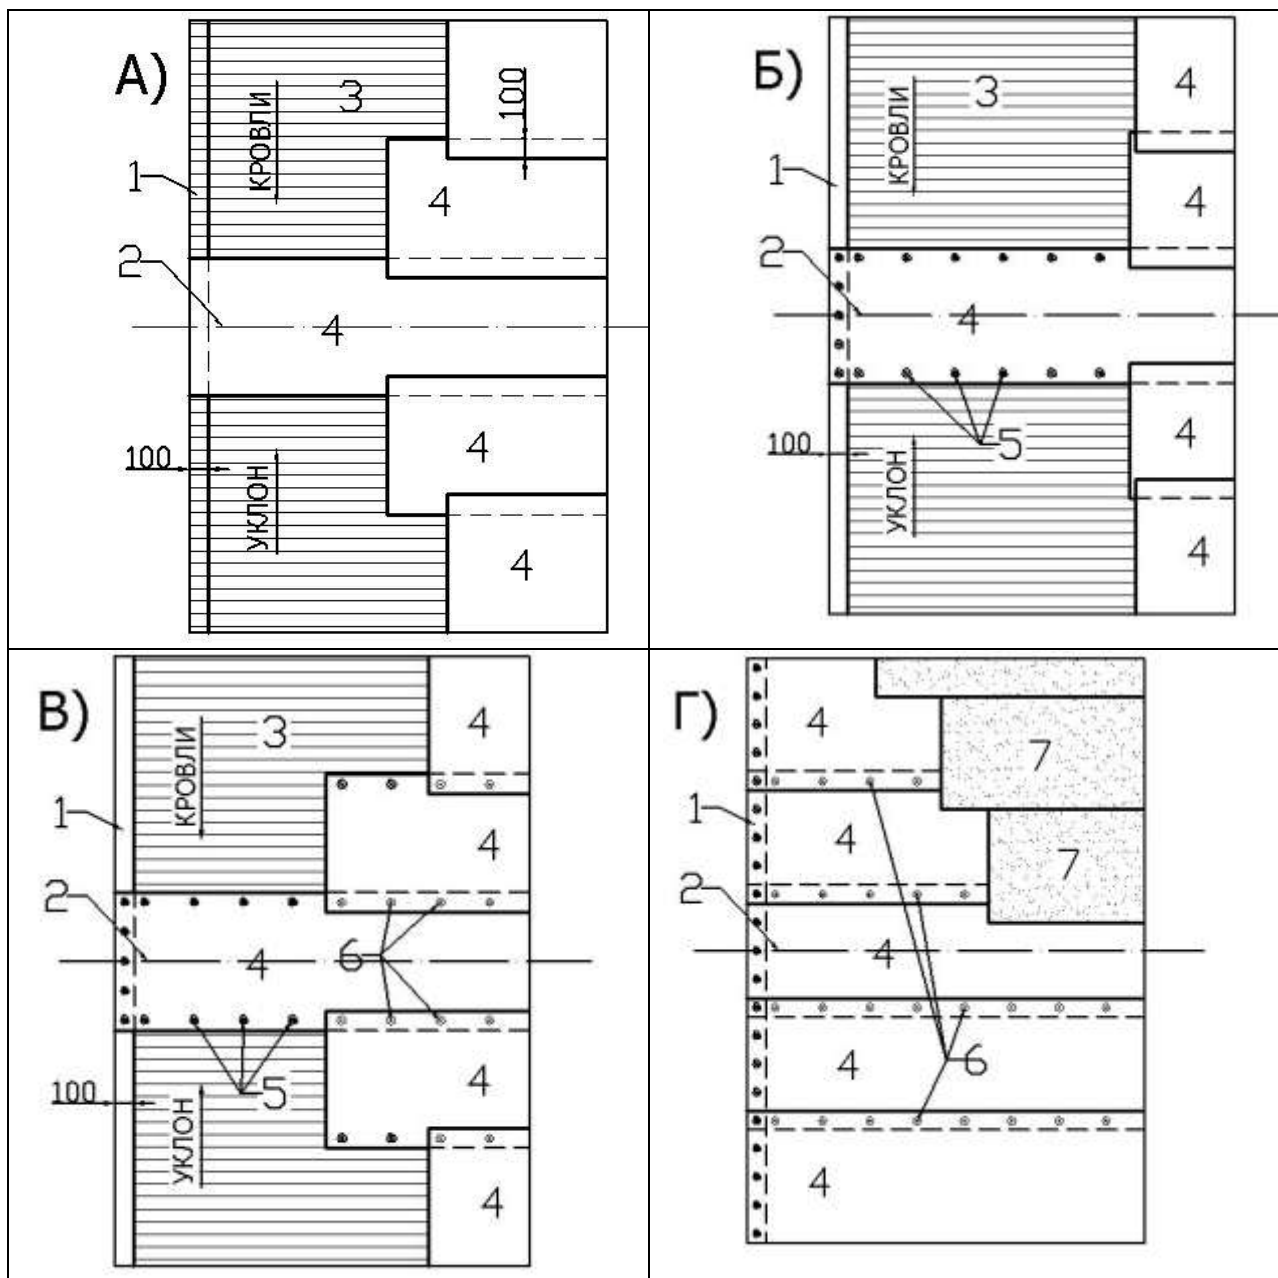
Пример раскладки рулонных материалов при устройстве кровельного ковра с механическим закреплением нижнего слоя
